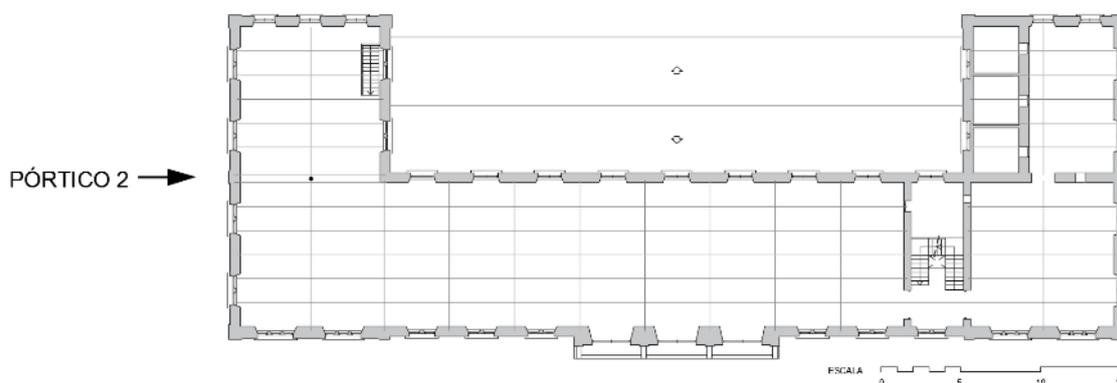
Esquema estructural. Pilar de planta tercera y entramado de cerchas y correas de cubierta.
